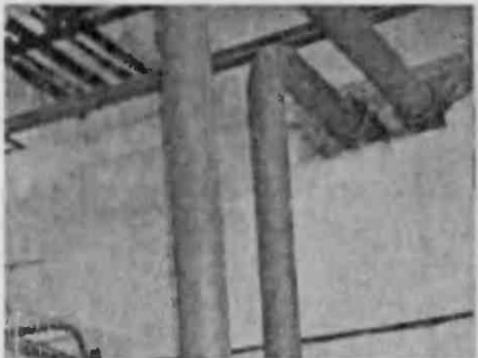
Прокладка трубопровода сквозь стену в гильзе
